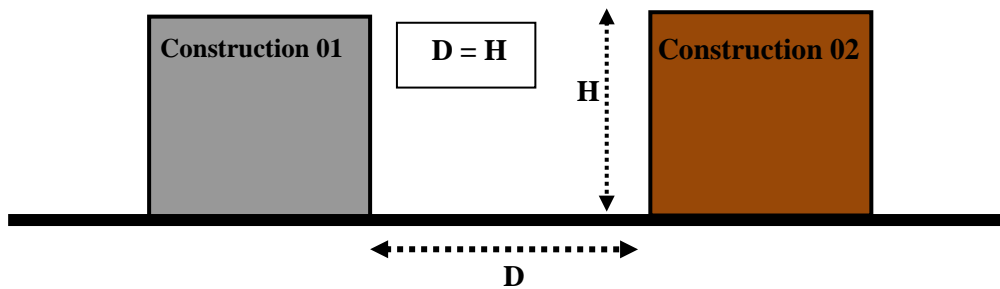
Coupe arrêtant la hauteur d'une construction en bordure d'une voie.
